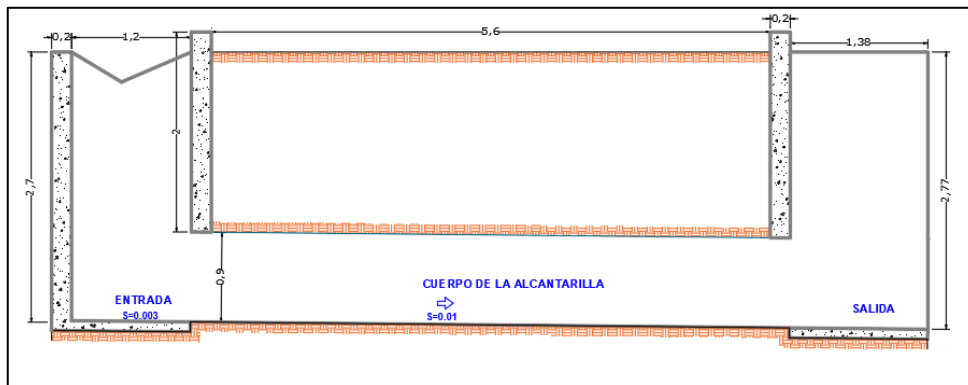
Vista en perfil de la alcantarilla N°01 existente.
